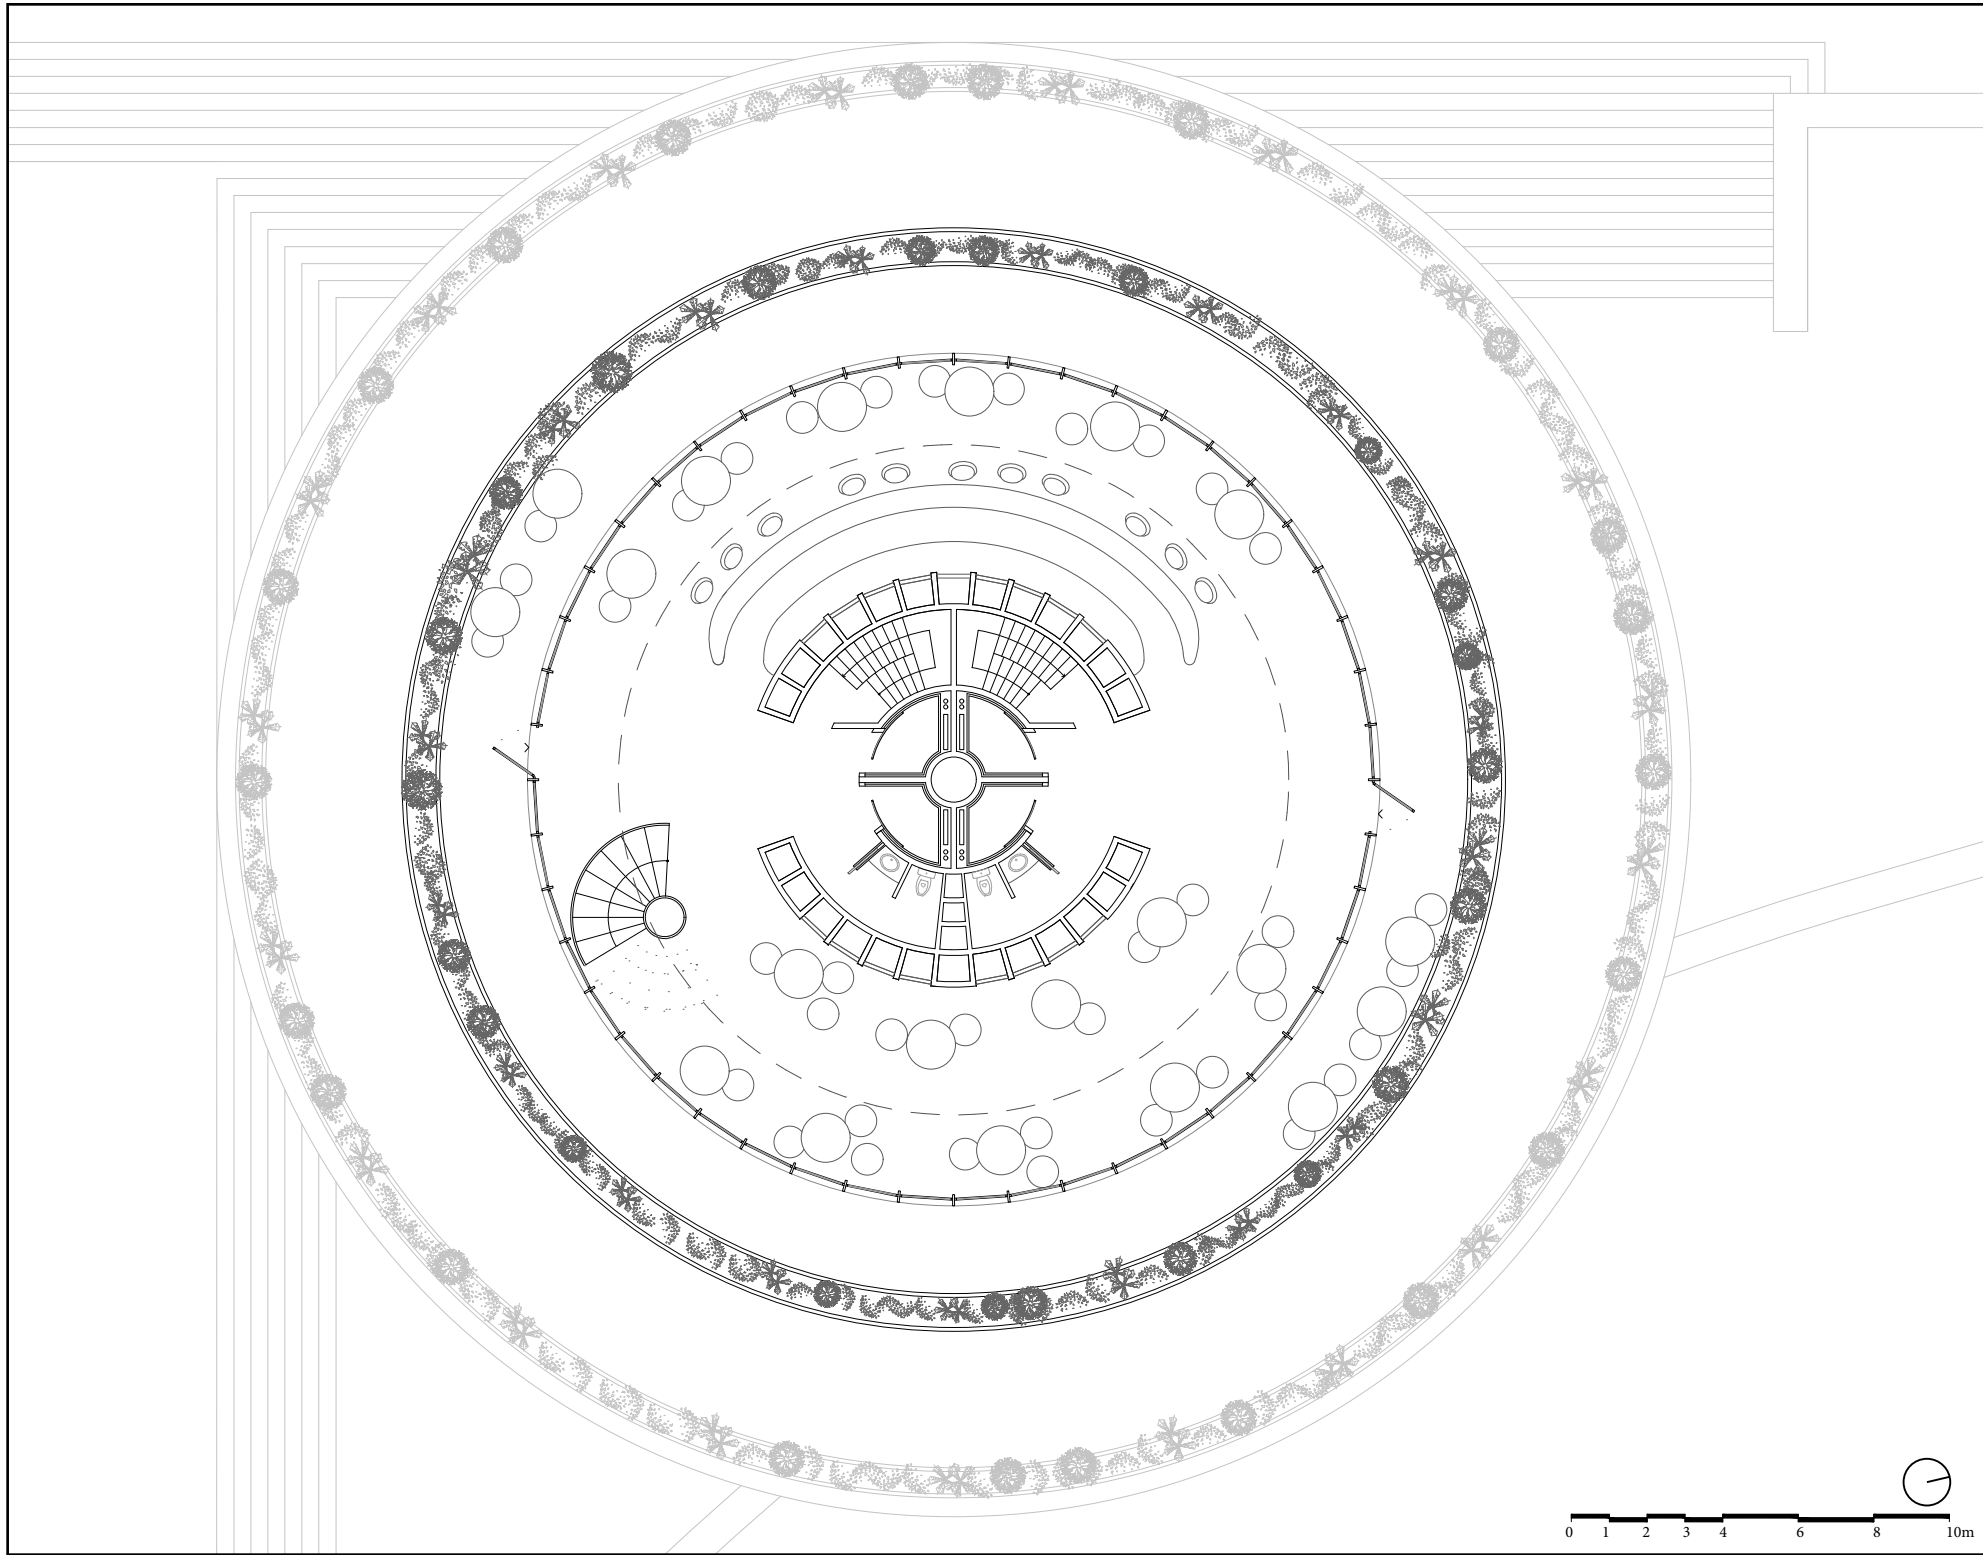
Sexta Planta. Bar. [Fuente: Autor]
